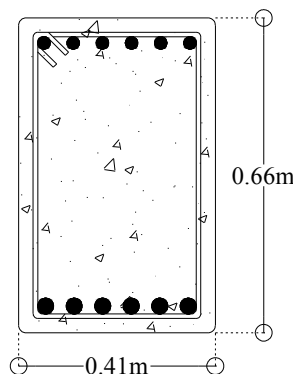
Viga de concreto reforzado (Ejemplo 1).
